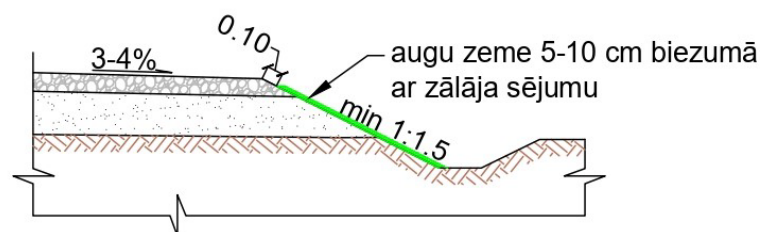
att. Ceļa segas konstrukcija uz zemas nestspējas grunts
